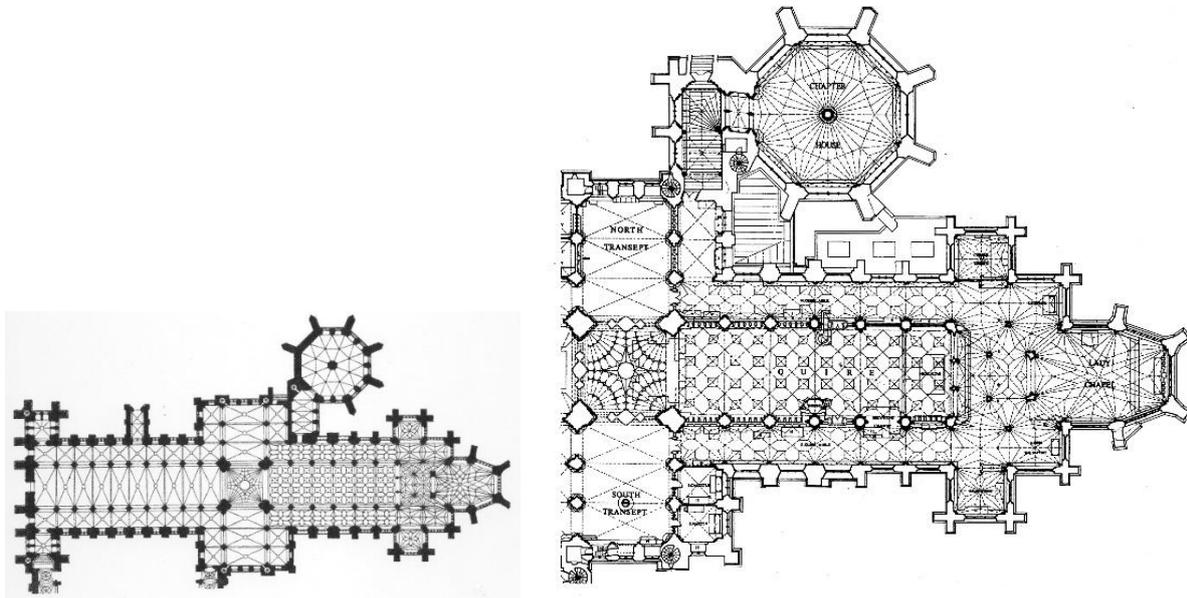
und 18 Wells, Kathedrale, Gesamtgrundriss und östliche Choreweiterung
